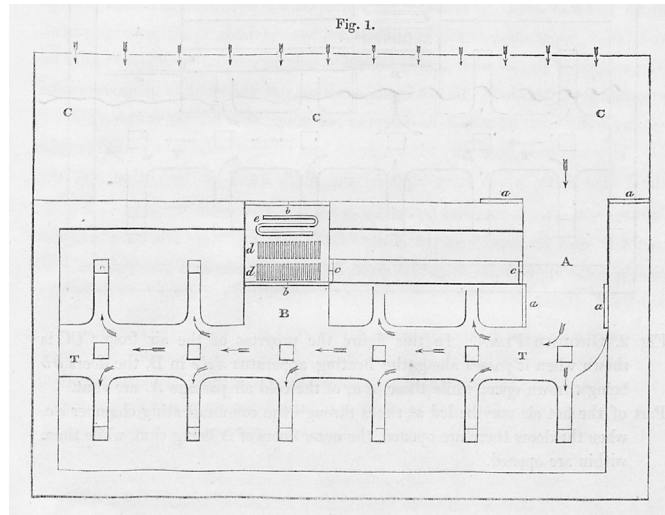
David Boswell Reid, Untergeschoss Temporary House of Commons, 1837
